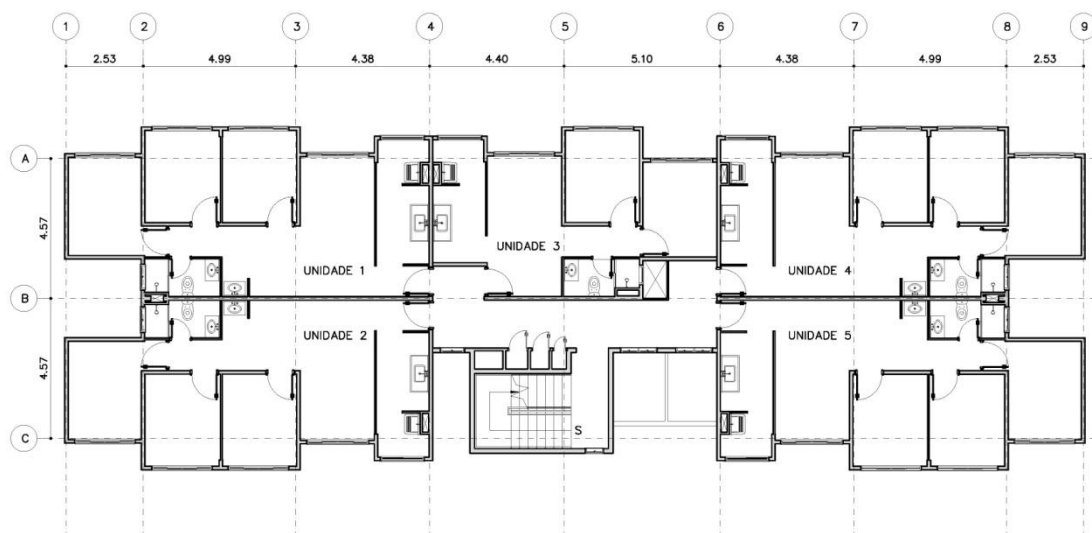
Planta Pavimento Tipo (V052-3) - sem escada; Fonte: Fernando Lima a partir de projeto da CDHU.
